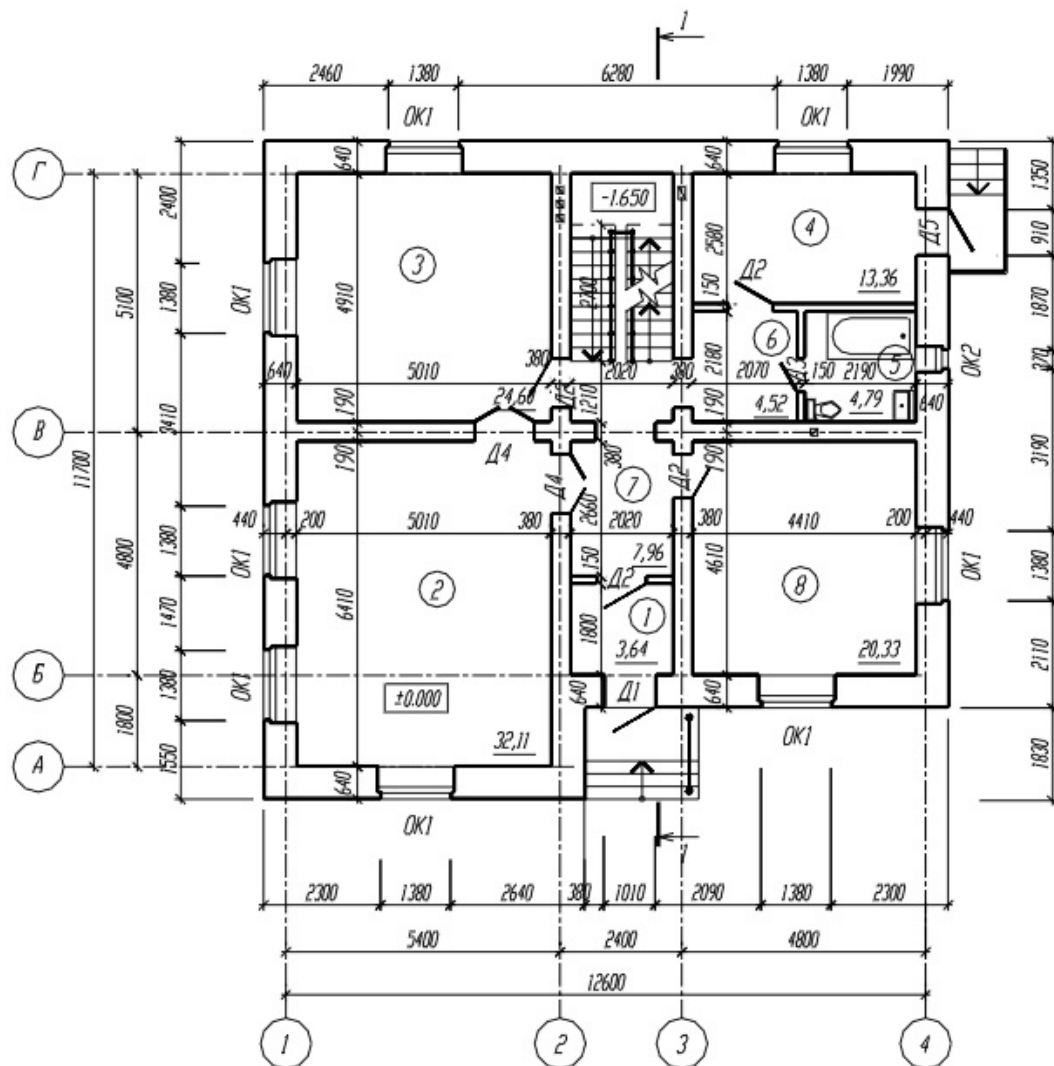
Пример оформления плана 1-го этажа жилого дома, со стенами из мелкоштучных материалов.
